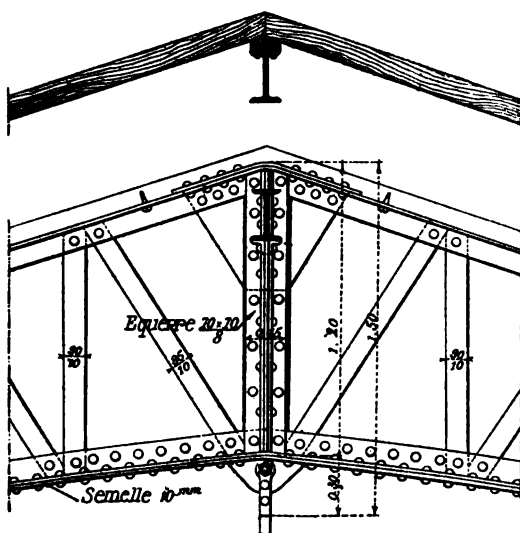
Assemblage de panne faitière sur montant vertical.
